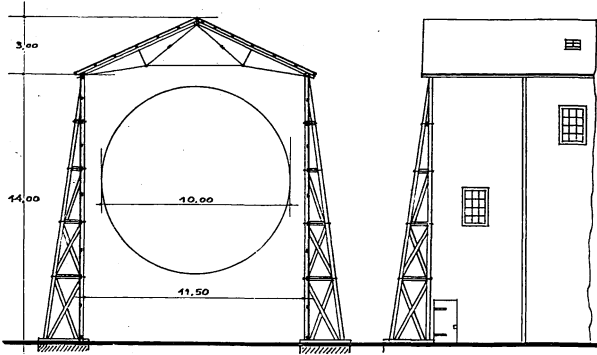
Stellt eine kleine Halle in Holzkonstruktion dar.
